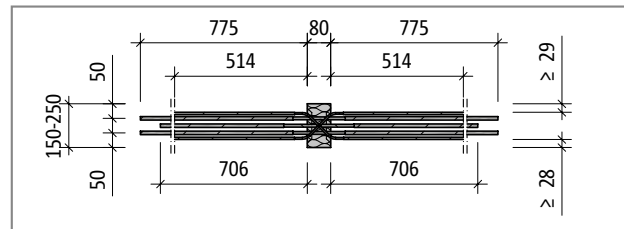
Schöck Isokorb® tipo W20M, pianta del prodotto
